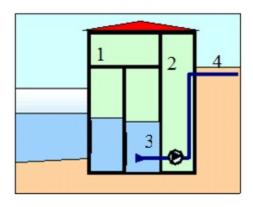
Насосная станция примыкает к береговому колодцу: 1 – береговой колодец; 2 – насосная станция; 3 – всасывающий трубопровод; 4 – напорный трубопровод
